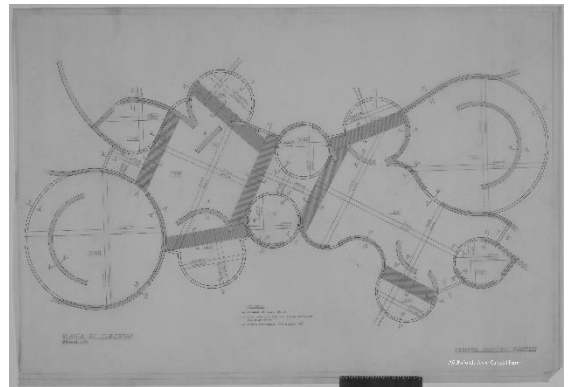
Instalación nº18. Planta de cimentaciones. Javier Carvajal. Archivo AGUN/207/Proyecto 198
